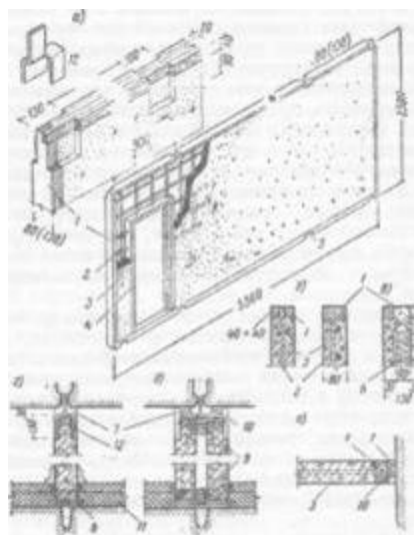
Гипсобетонные крупнопанельные перегородки
